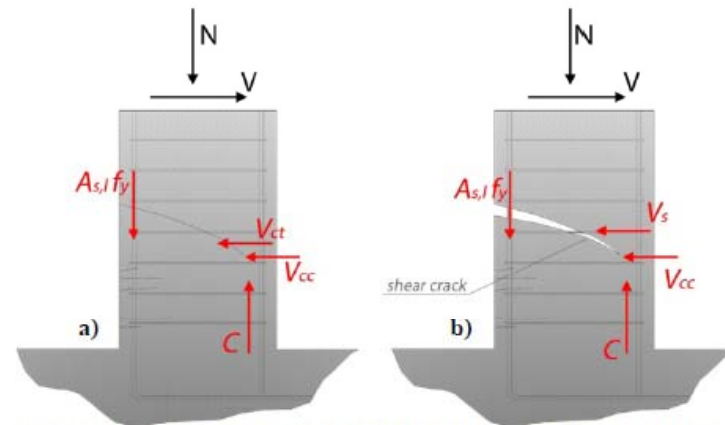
Schematizzazione del modello meccanico per a) elementi non fessurati e b) elementi fessurati
